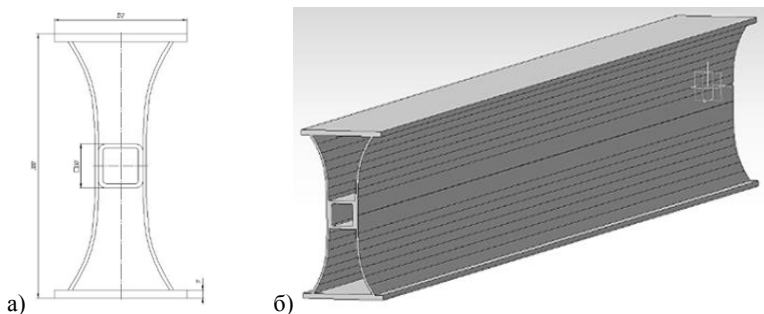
Спроектированная конструкция главной балки с гнутыми боковыми стенками:
